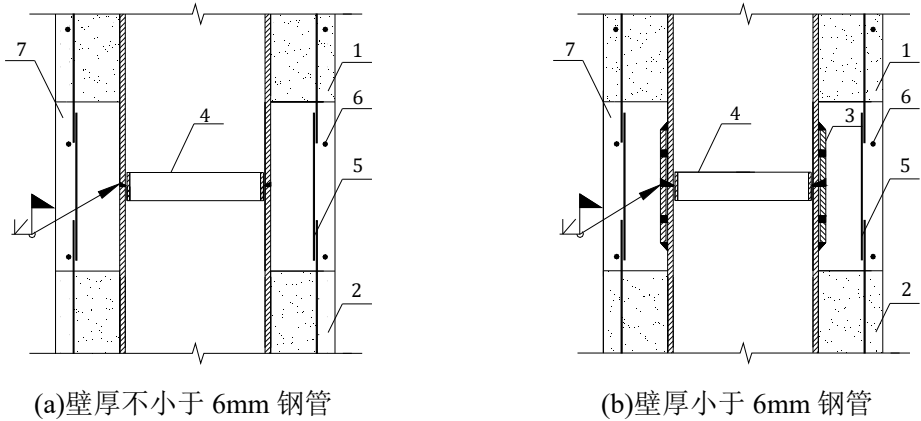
排钢管构件上下拼接连接示意 2——钢管对接焊接
